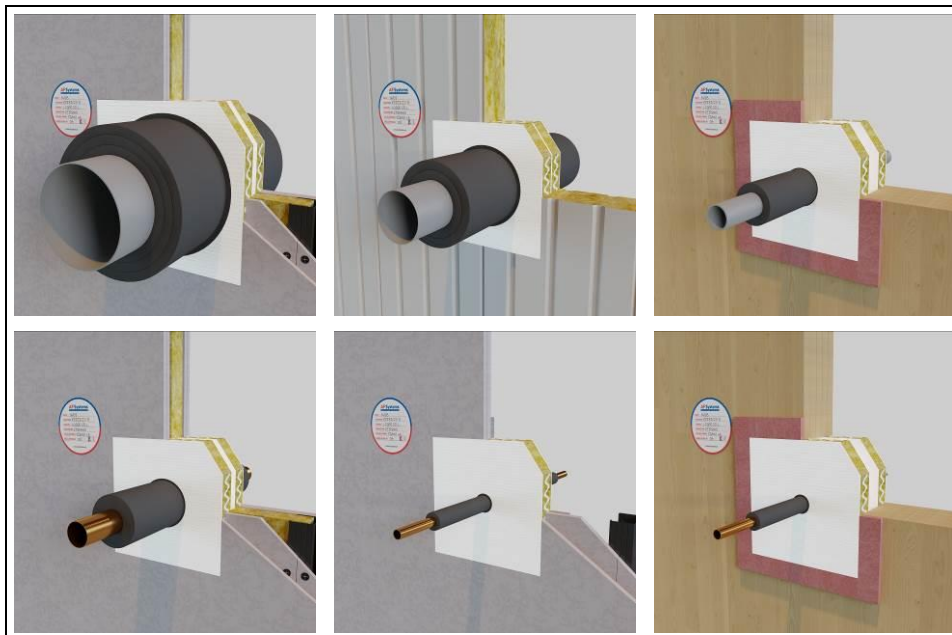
Ejemplo de sellado de tuberías metálicas aisladas (con AF SLEEVE) en paredes.
